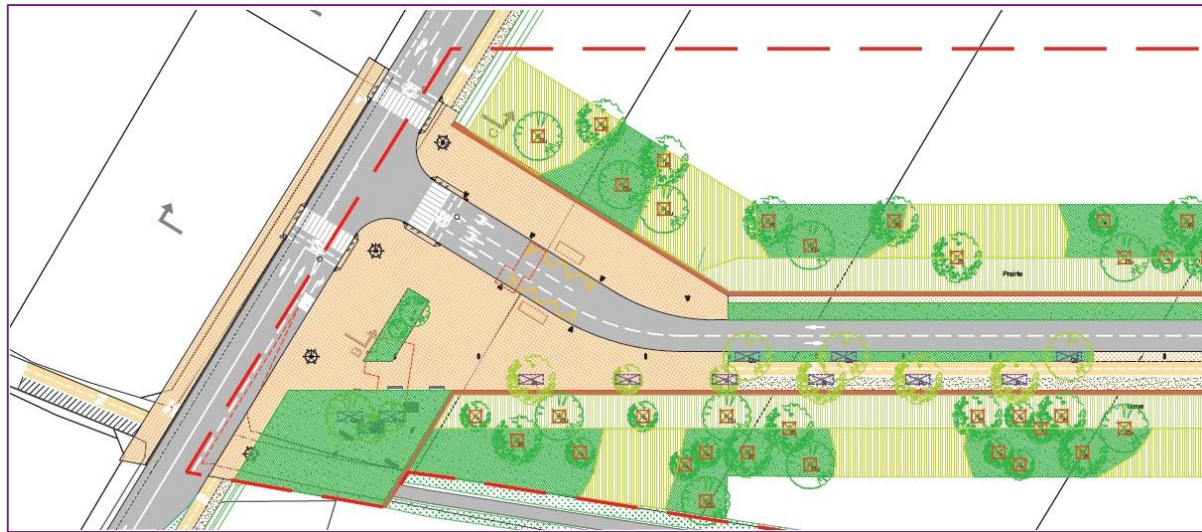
Vue en plan du raccordement de l'avenue de la Gare sur la RD3
